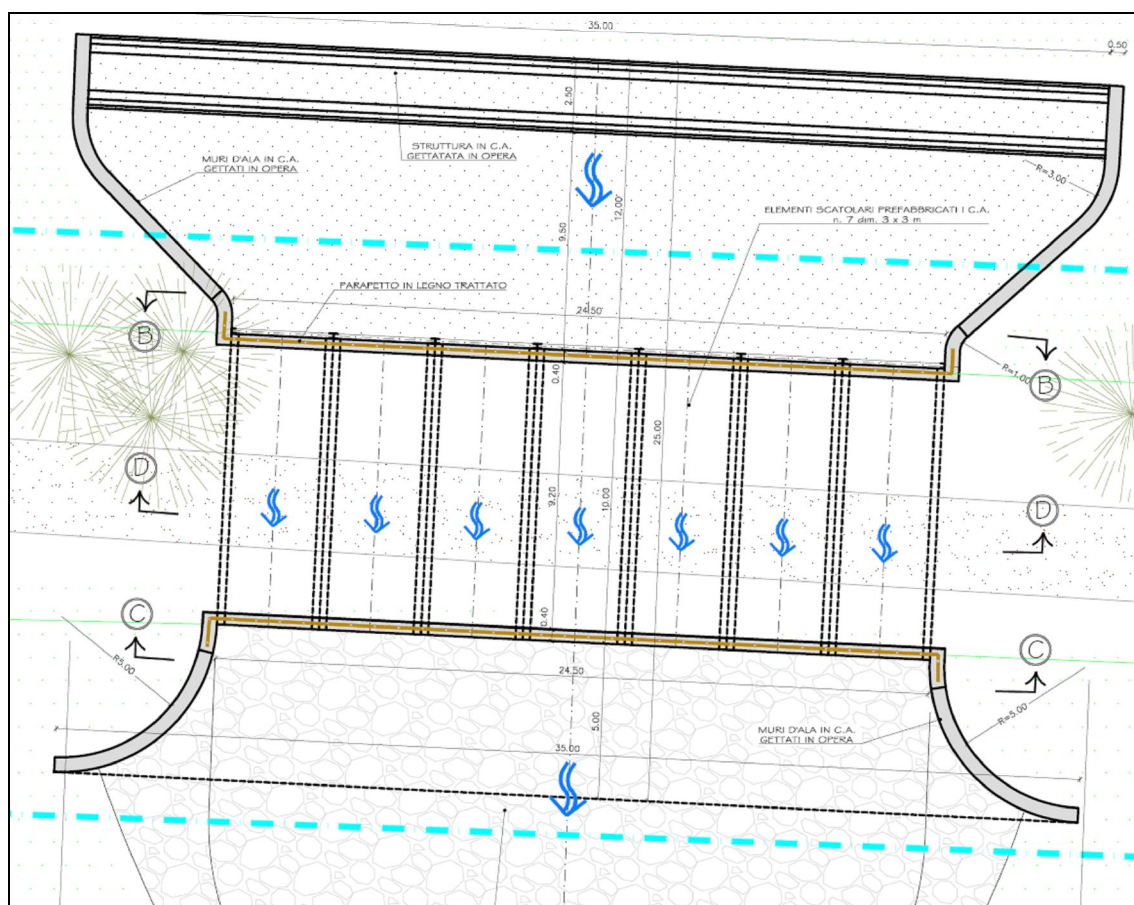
Stralcio planimetrico del manufatto di sfioro per collegare il I al II settore dell'invaso
